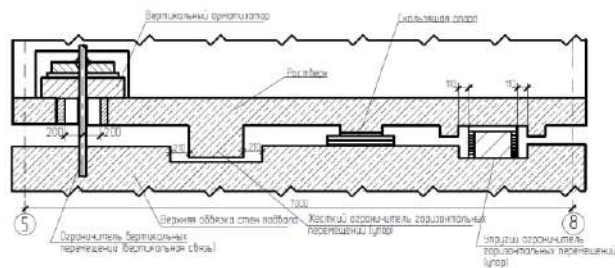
Конструкция сейсмоизолирующего пояса в проектируемом здании
